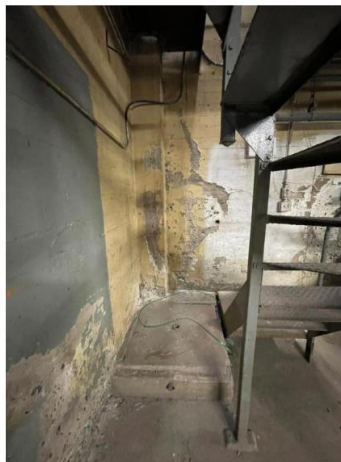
Mur de béton fortement dégradé au sous-sol, avec éclats et efflorescences
